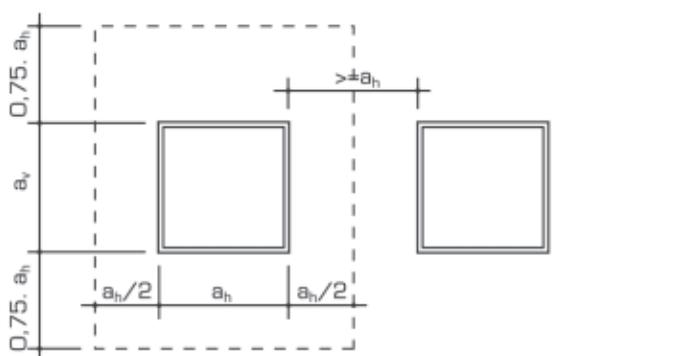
Ilustração de distribuição horizontal de aberturas em uma parede de concreto
